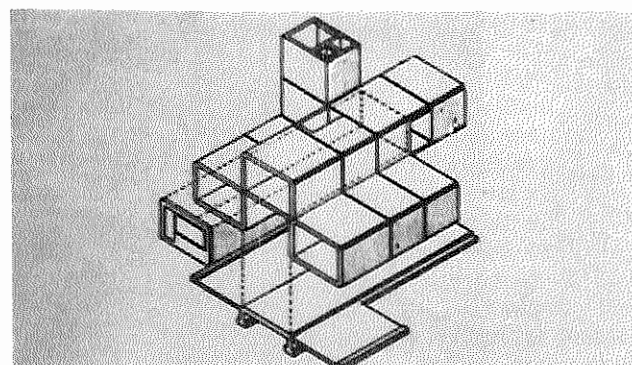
Caixa – “com diversas formas – componentes, conjuntos ou subsistemas completos – mas o elemento estrutural é sempre uma unidade tridimensional de tamanho pequeno, médio ou grande”.
